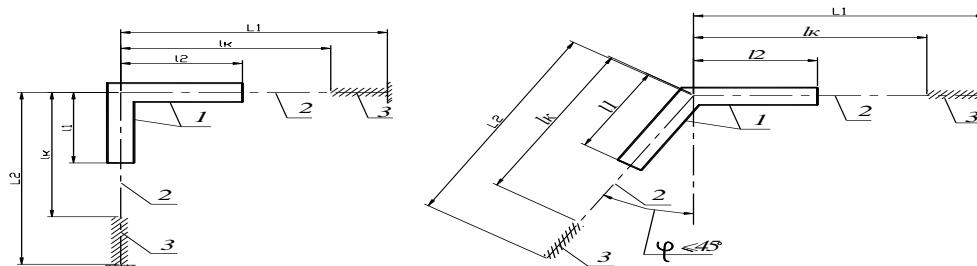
Расчетная схема самокомпенсации при Г-образных поворотах трассы теплопроводов.
